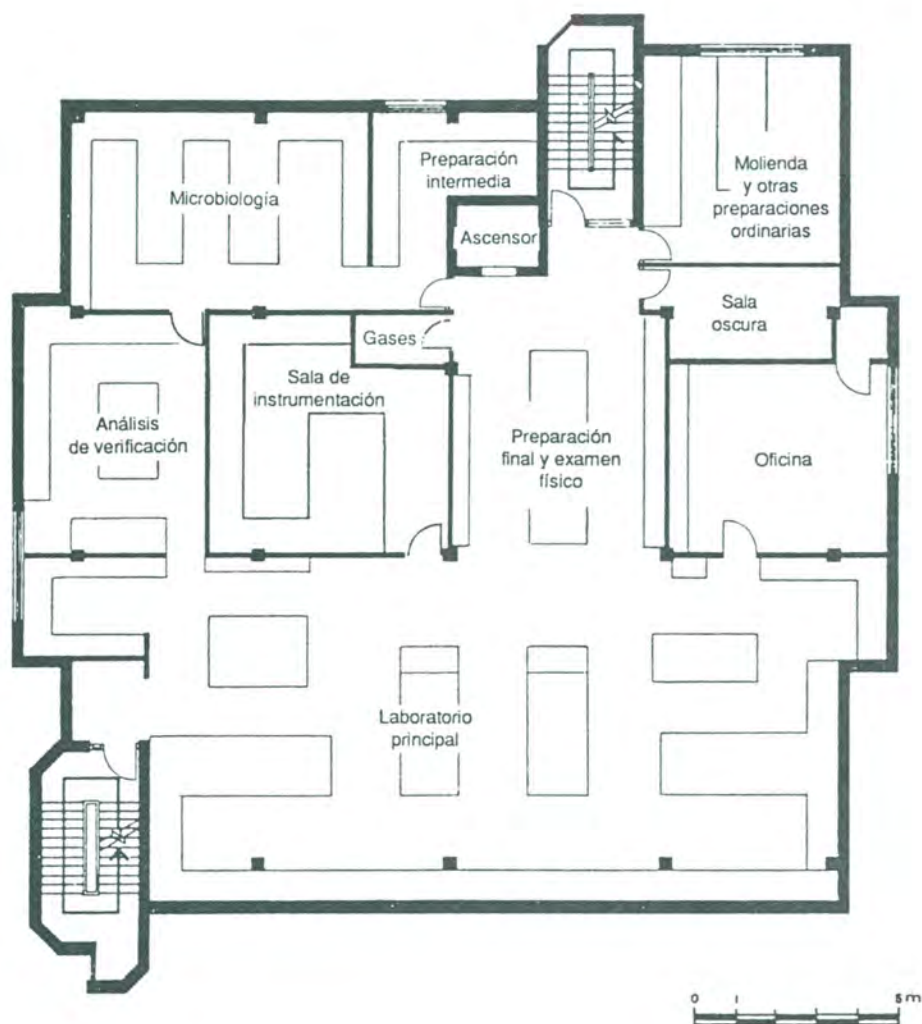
Plano de la primera planta (espacio del laboratorio)
